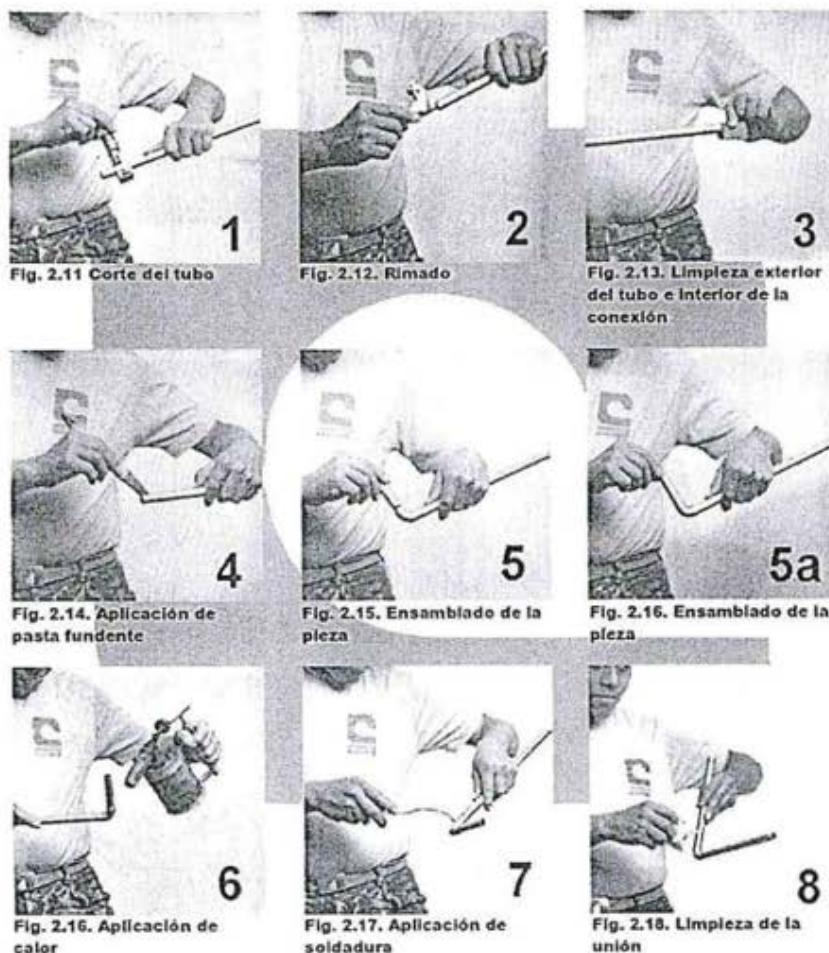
Procedimiento constructivo para el soldado de la tubería de cobre.
